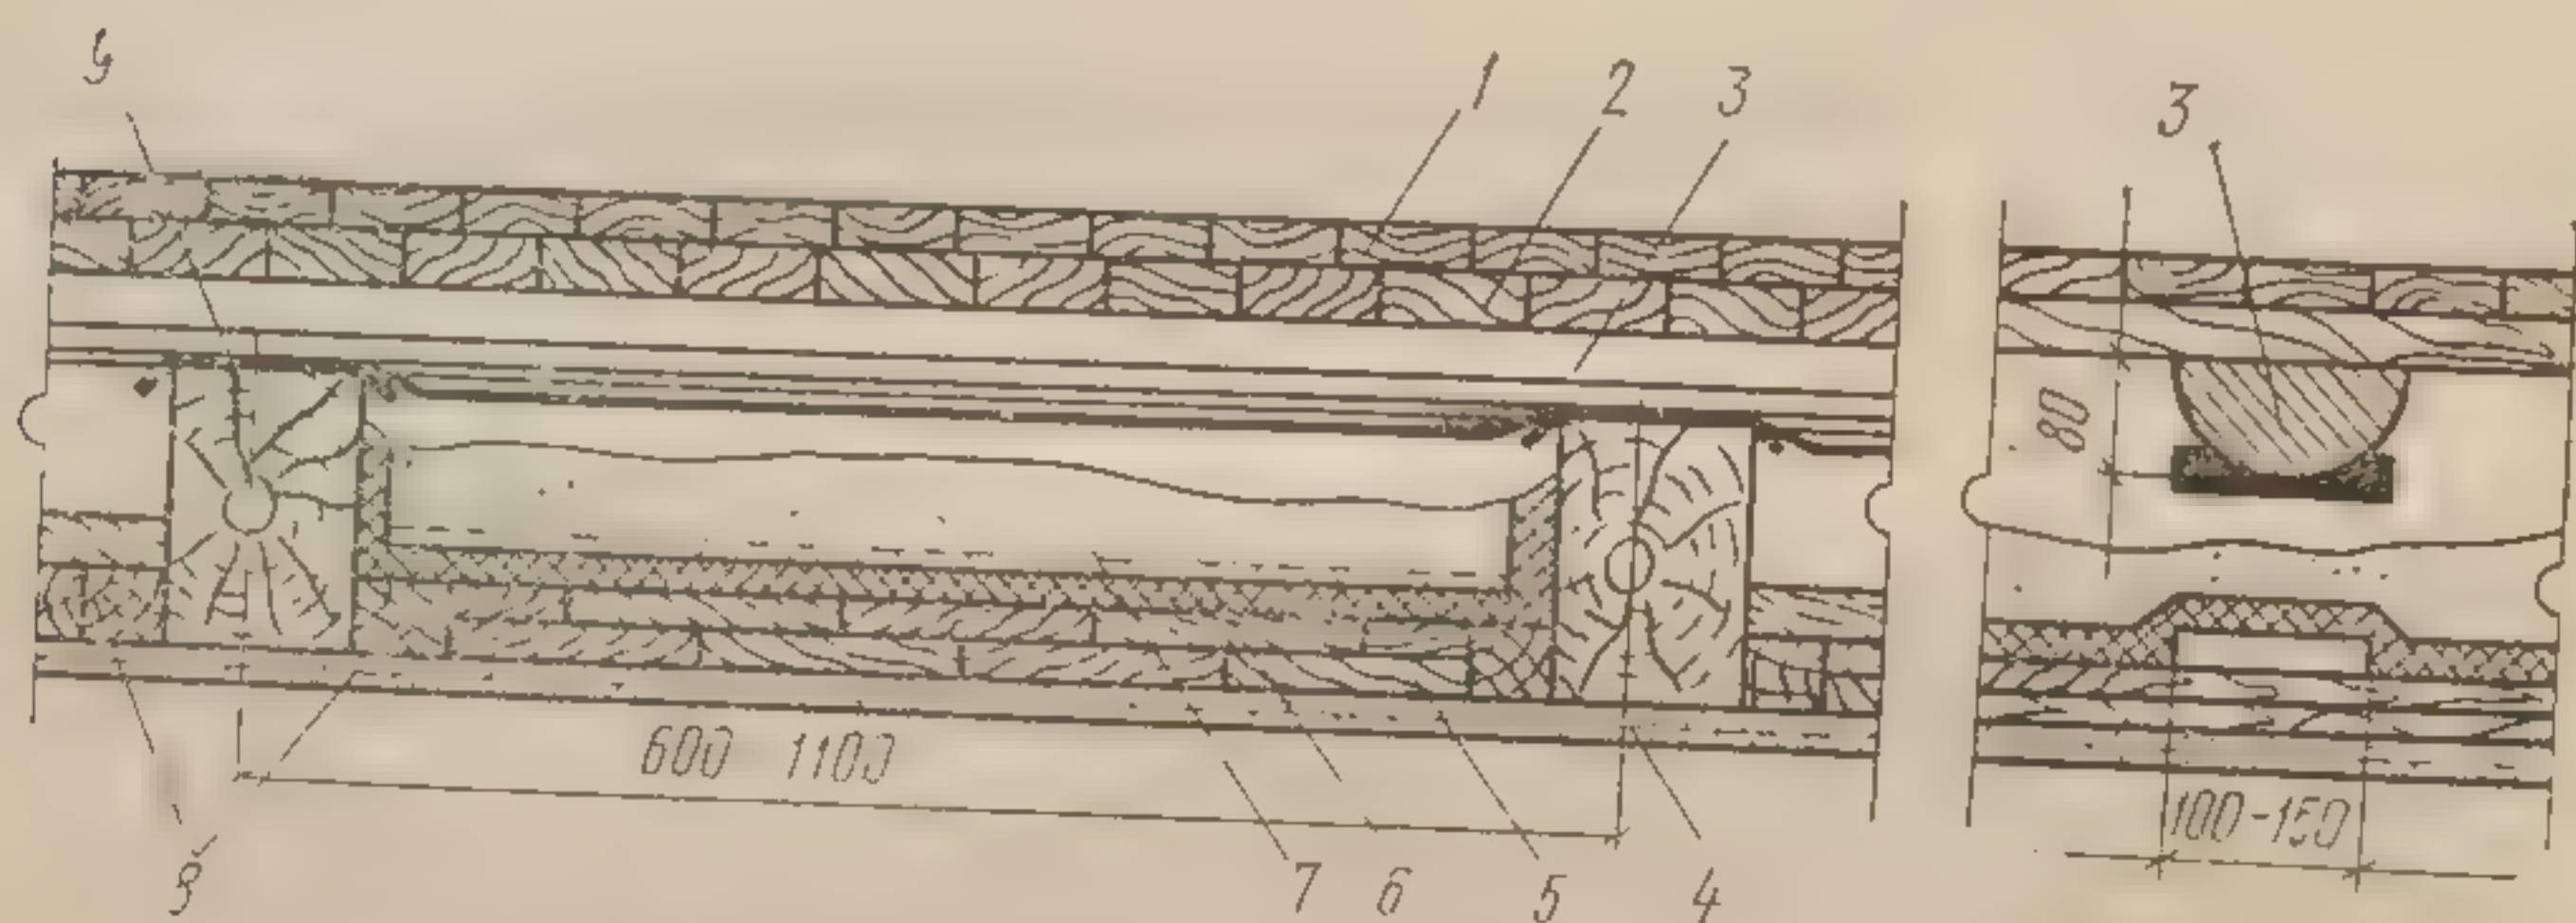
Деревянное междуэтажное перекрытие по деревянным брусчатым балкам:
